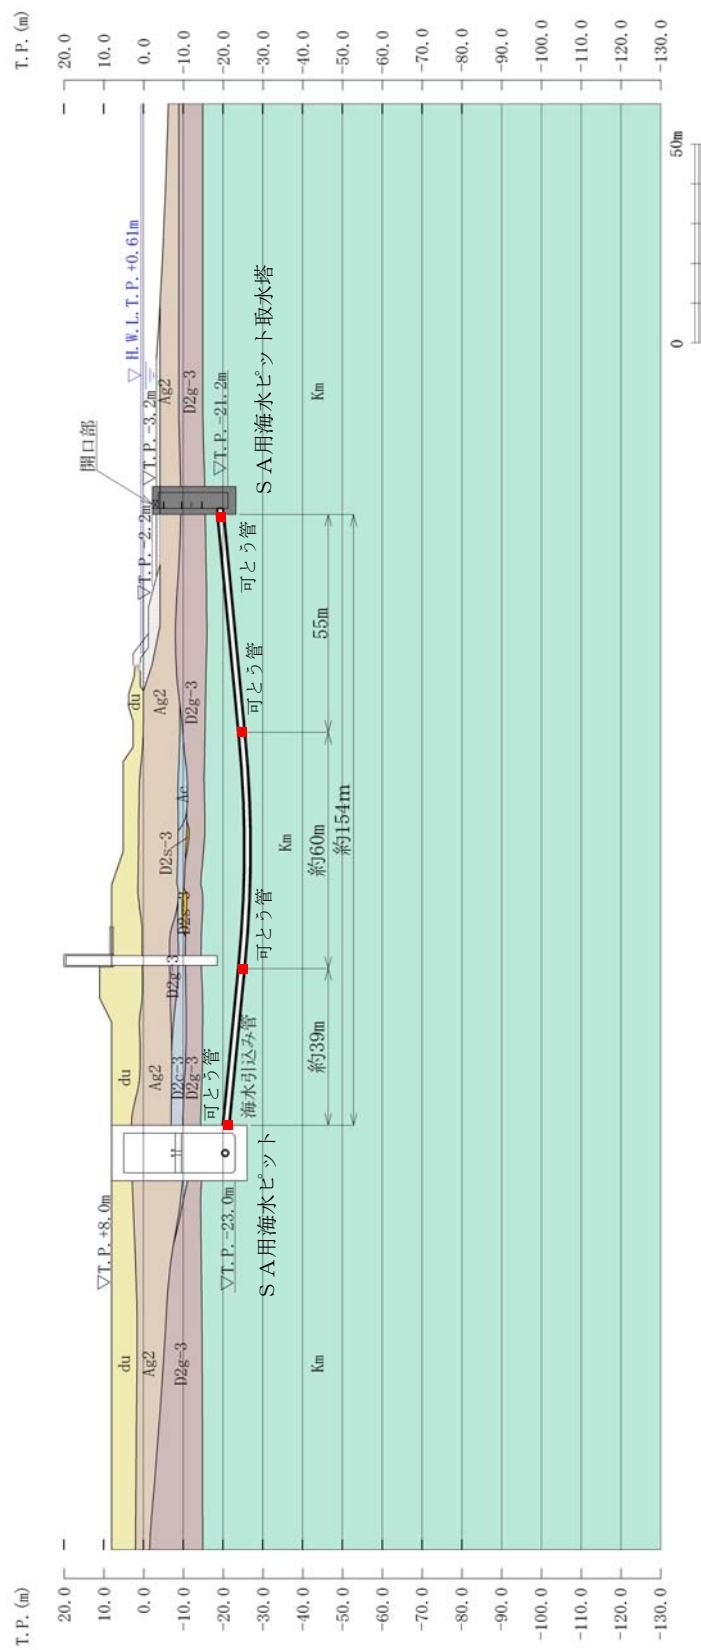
(1) S A用海水ピット取水塔 評価対象断面図 (①-①断面)
